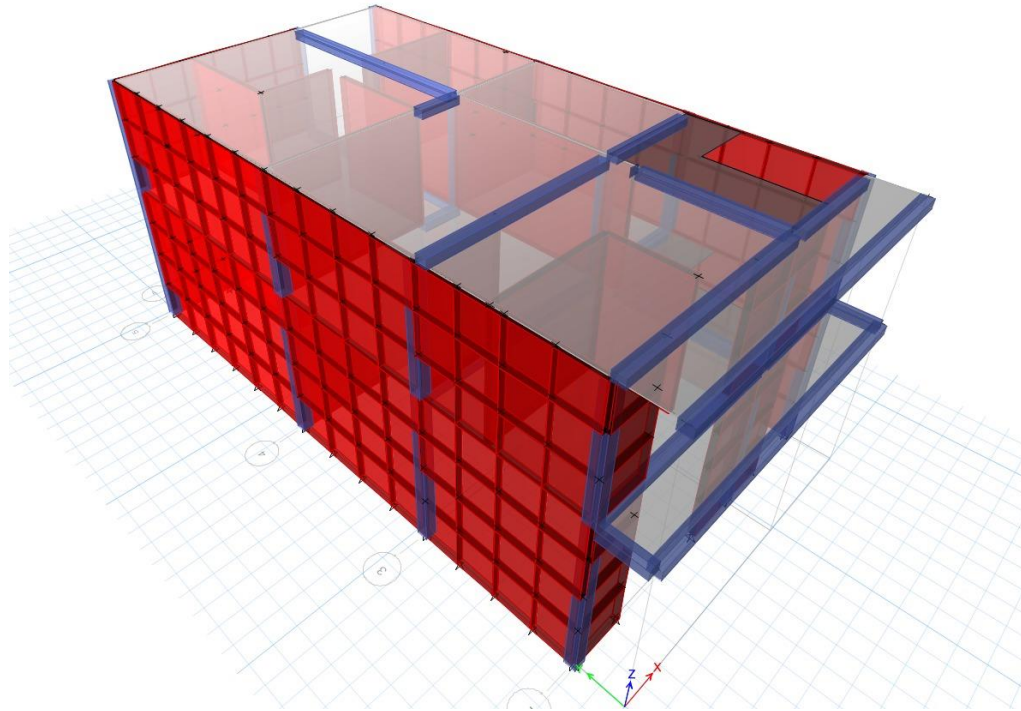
Vista de Elevación de la vivienda – ETABS (Vivienda Estructurado)
